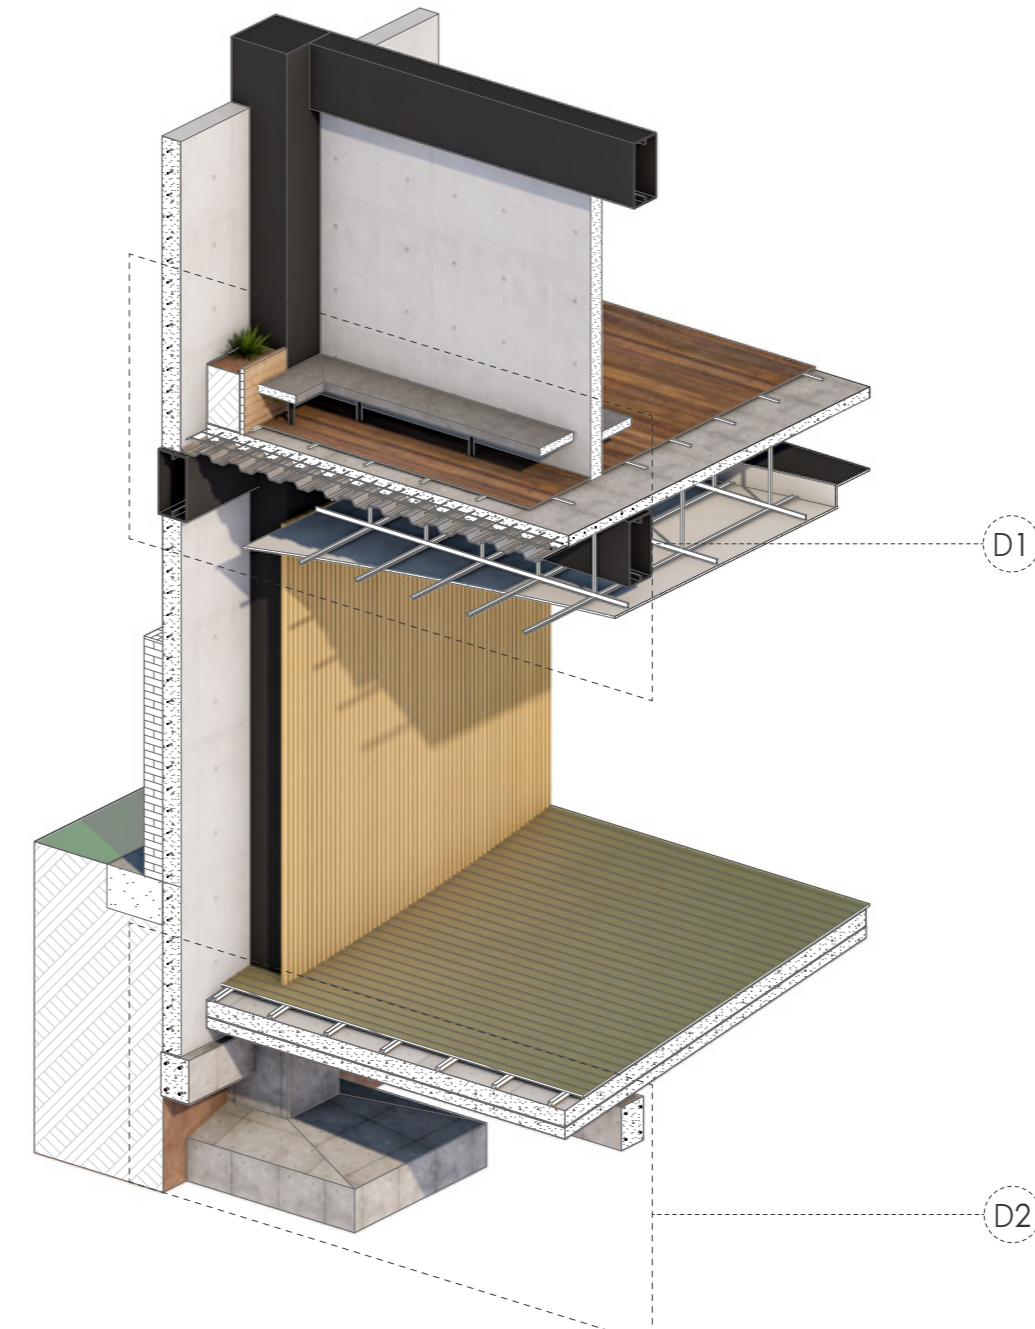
Sección constructiva 2do septenio | Fuente: Elaboración propia
